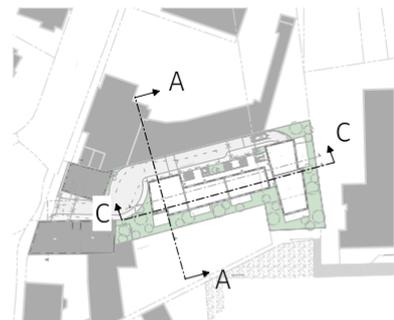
Dachaufsicht und Höhenvergleich (Juni 2022)
